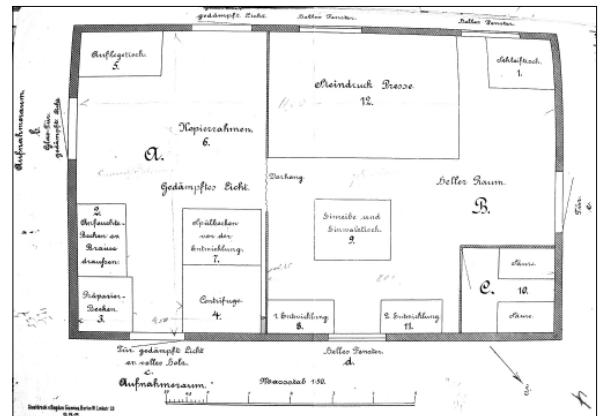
Plan der Druckerei, gebaut 1909 (NNA, BAU-34, Druckerei-LV)
